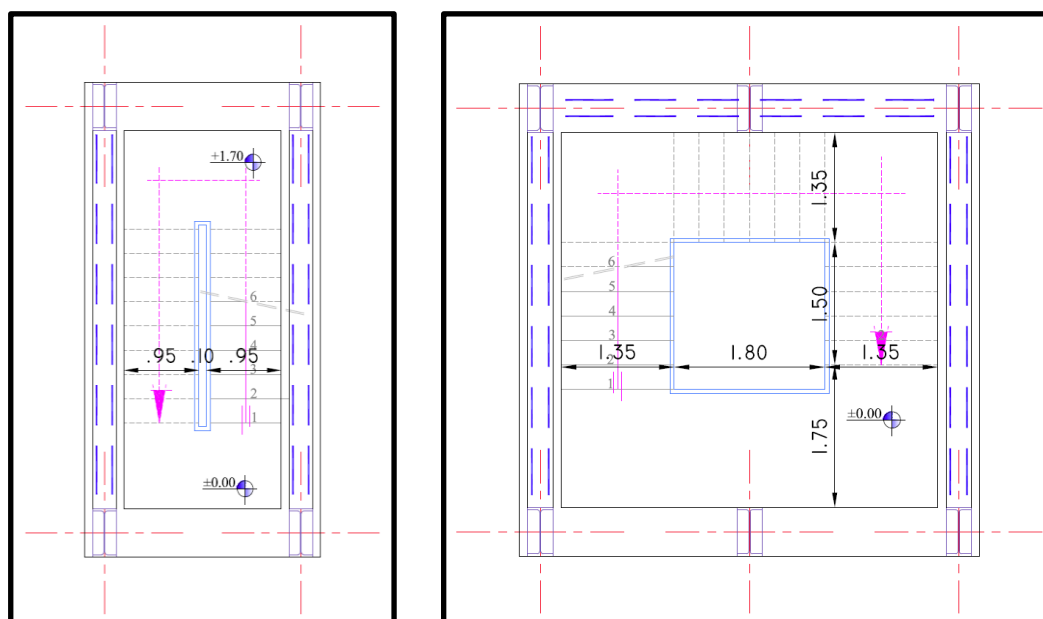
Vue en plan des escaliers [Autodesk AutoCAD]
